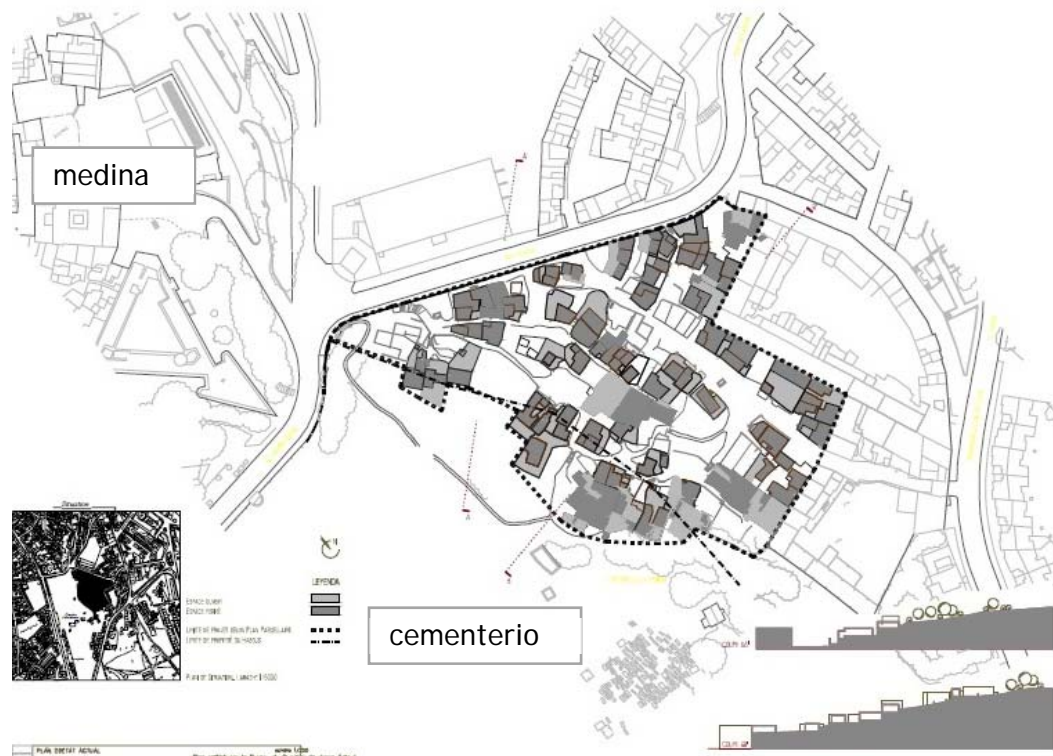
Plano del estado inicial antes de comenzar las obras en las viviendas. Fuente: Bureau du Quartier de Jnane Aztout (2008)
